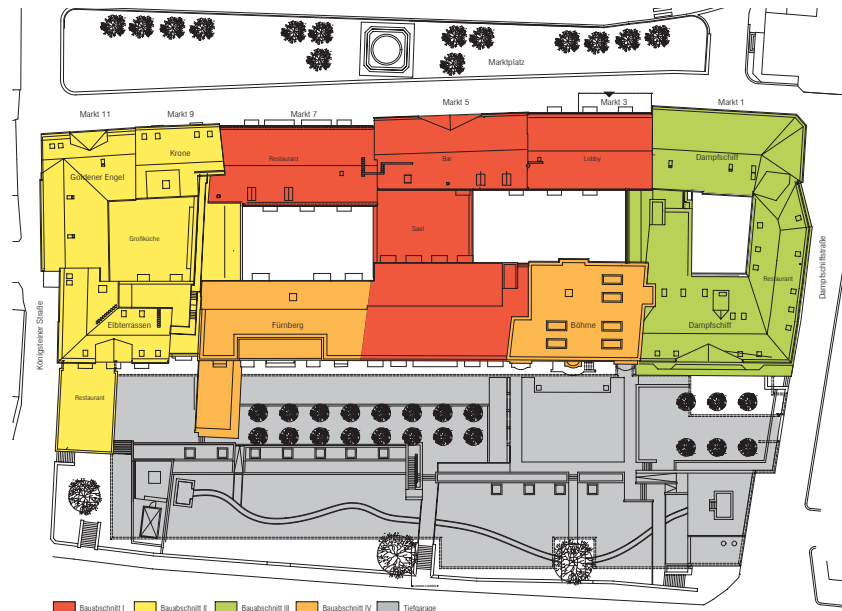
Lageplan mit Übersicht der einzelnen Bauabschnitte
